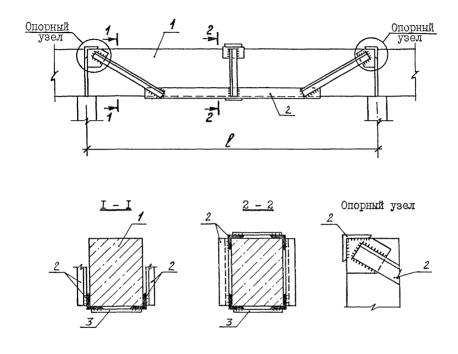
Усиление железобетонной балки стальным шпренгелем
